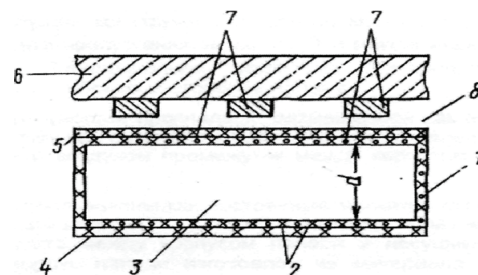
Схема звукоизолирующей конструкции Абракитова В.Э.
